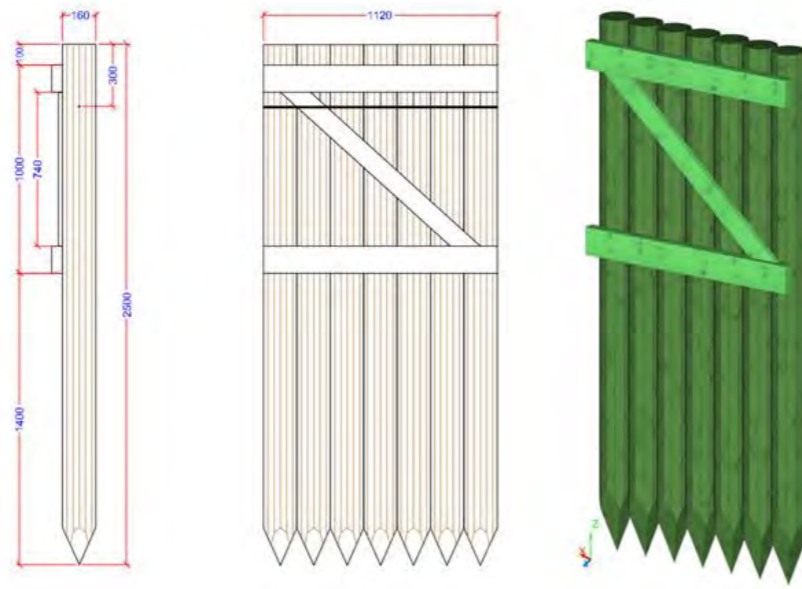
Sección de detalle de los pilotes de madera de la empalizada de encauzamiento del arroyo. Fuente: MITECO.
